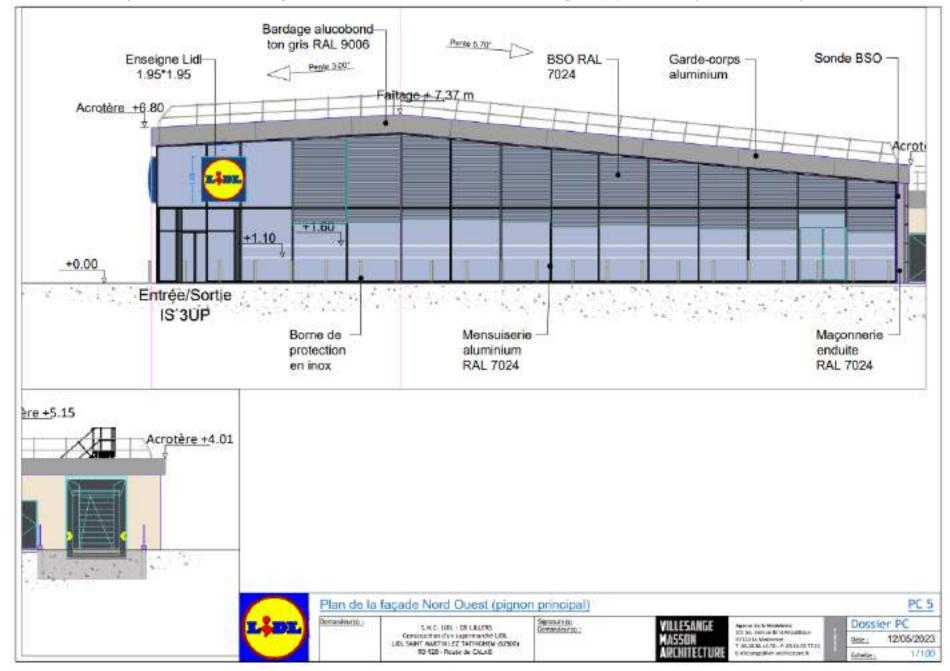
Plan de la façade nord -ouest; Source: Villesange Masson Architecture
